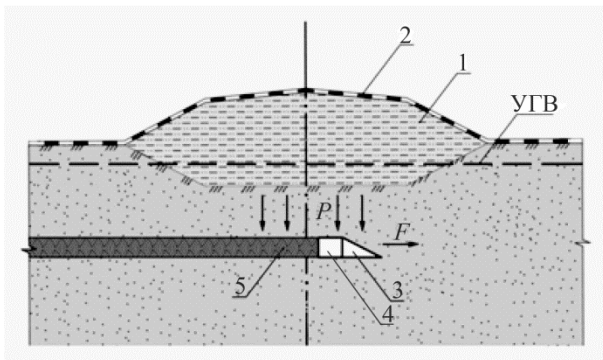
Схема сил, действующих на рабочий орган: P – вертикальное давление; F – усилие перемещения рабочего органа (ножа); 1 – хранилище отходов; 2 – надземная гидроизоляция; 3 – нож рабочего органа; 4 – стабилизатор рабочего органа; 5 – ГПЭ
